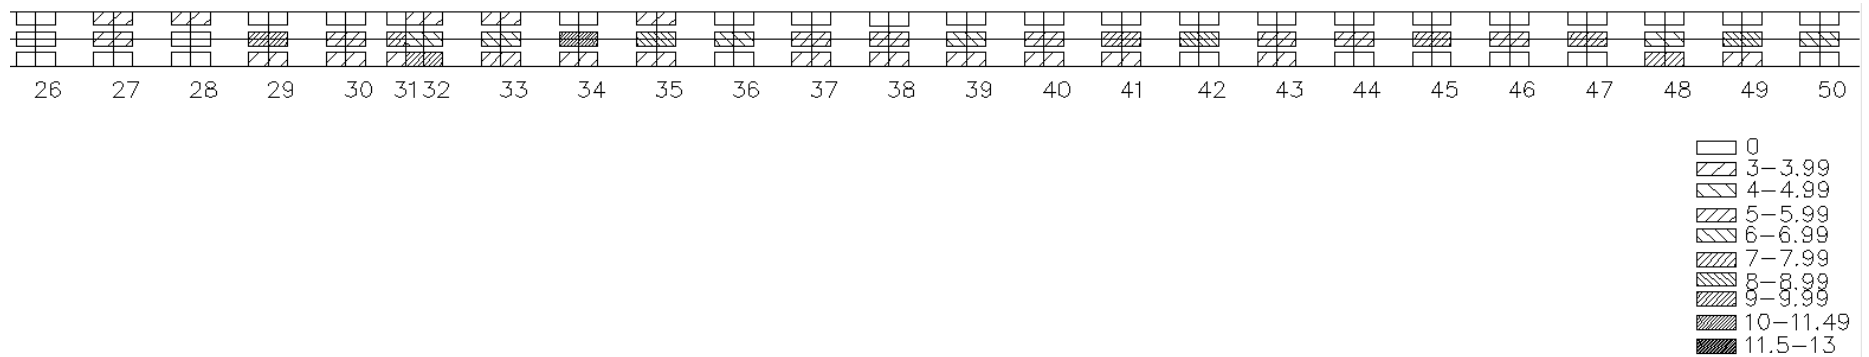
Ausgleichungsdicke bei kubischer Splinefunktion und Verfahrensplan Typ V, Grundriss, Stationen 26-50
